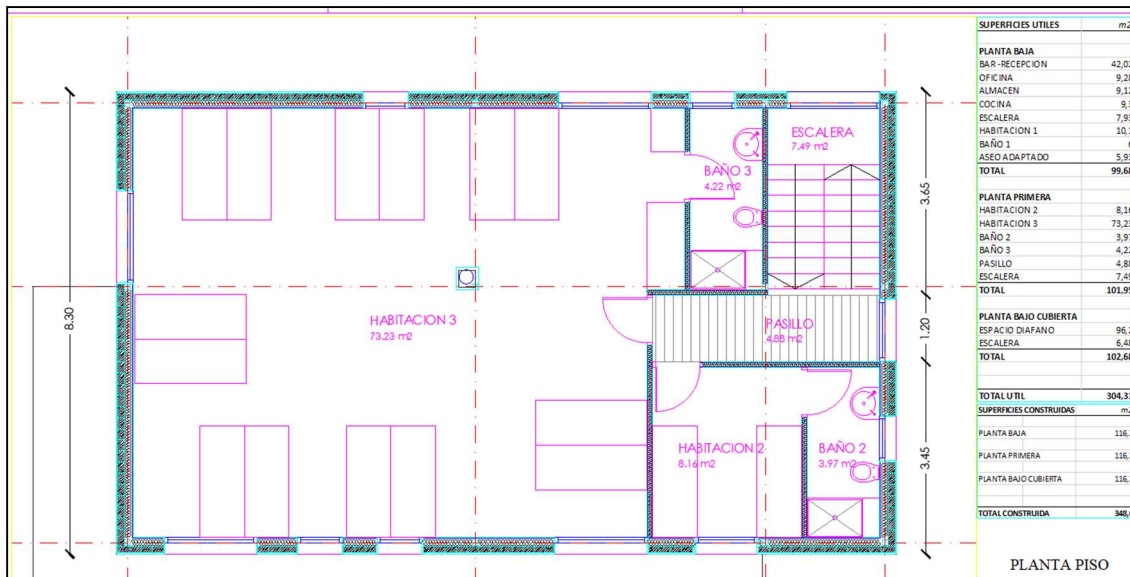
Plano de la planta primera. (Fuente: Proyecto básico y en ejecución Albergue en Sabayés, Nuero (Huesca) (Gavin, 2017))
